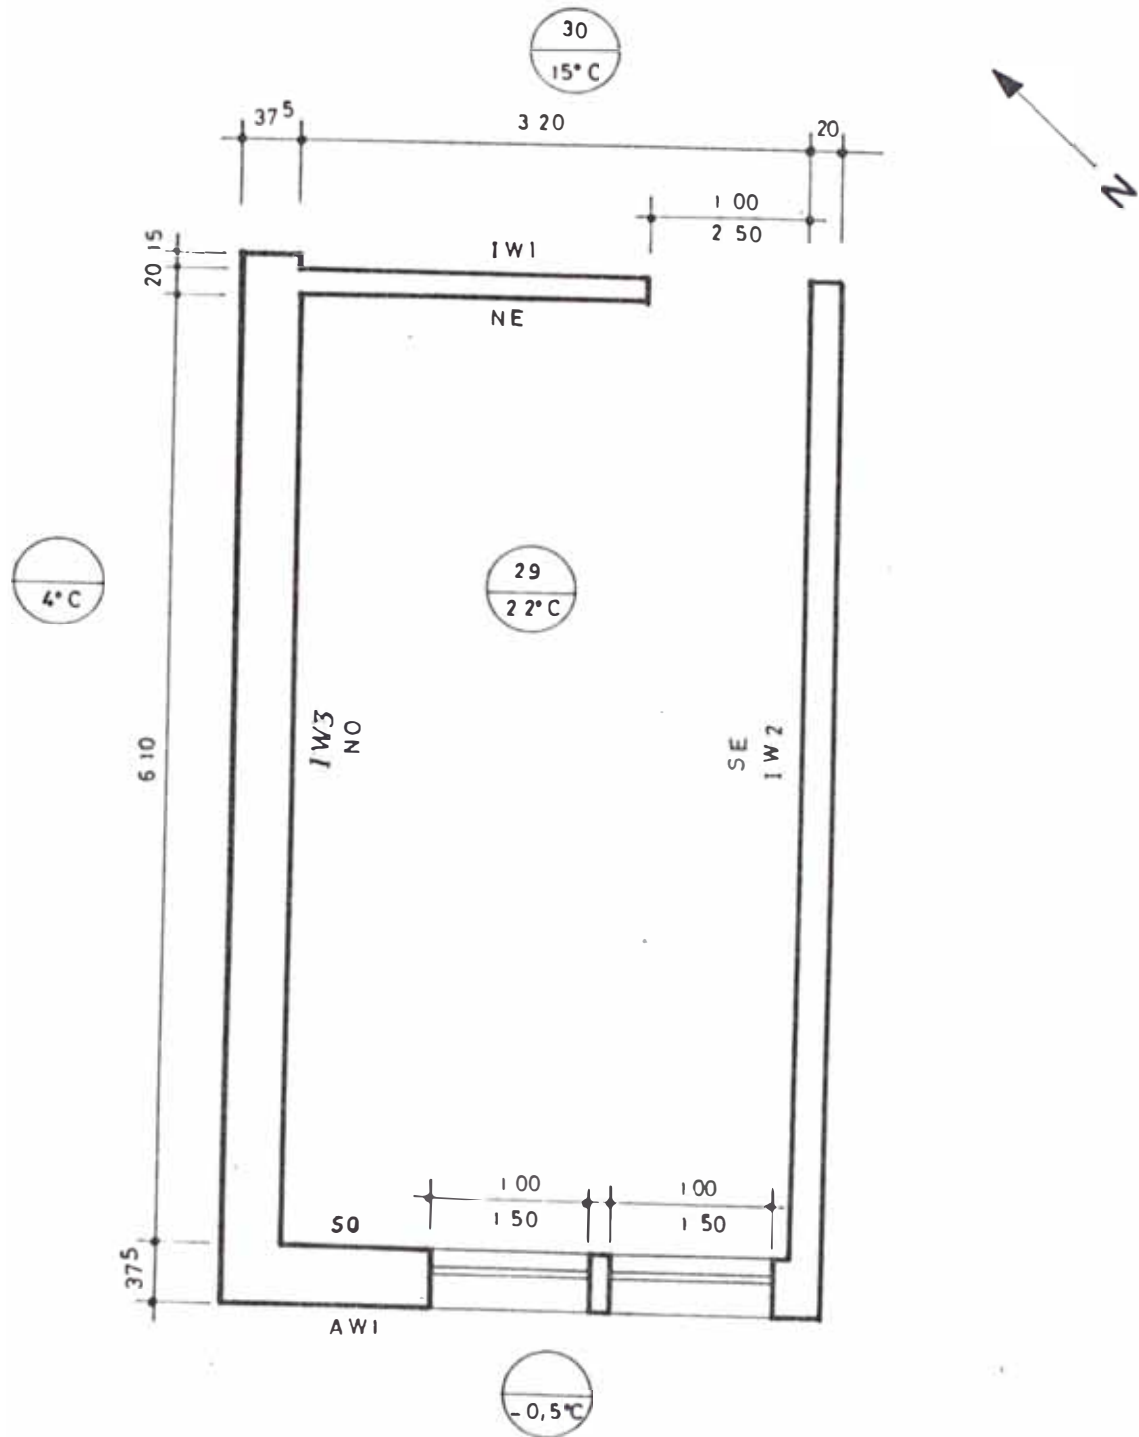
VISTA DE PLANTA DEL AMBIENTE 29 DE 4 CAMAS
